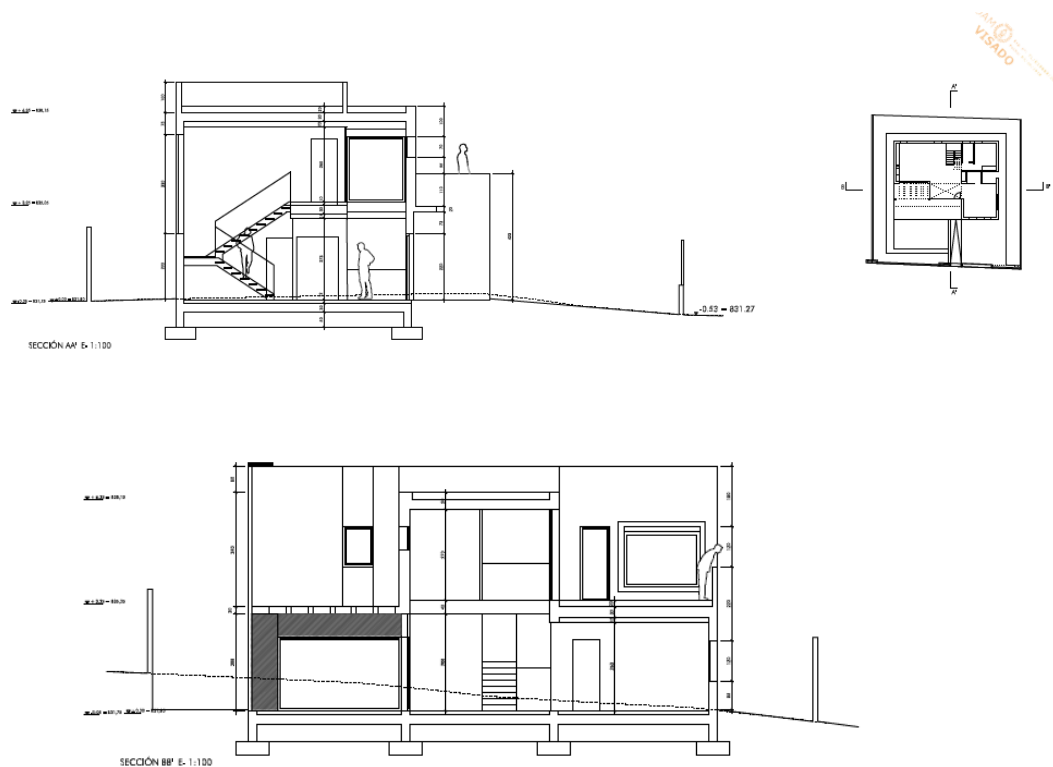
Sección de arquitectura 1. Fuente: Arhotek
